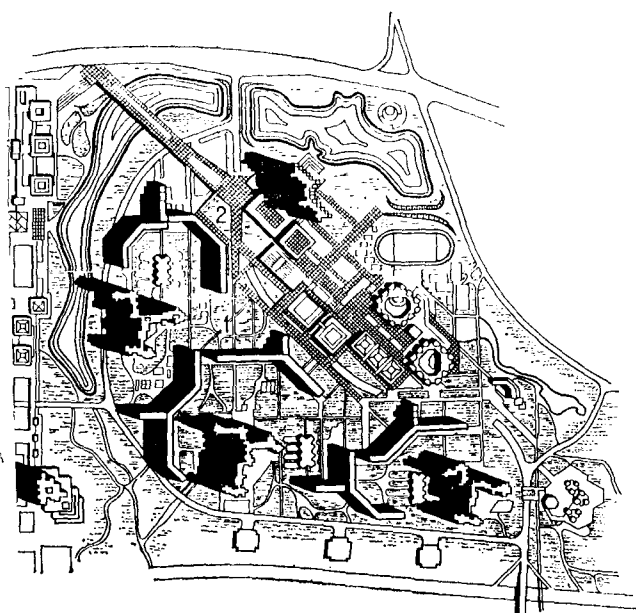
Застройка жилого комплекса Северное Чертаново в Москве акцентирована зданиями повышенной этажности. Ген-план
